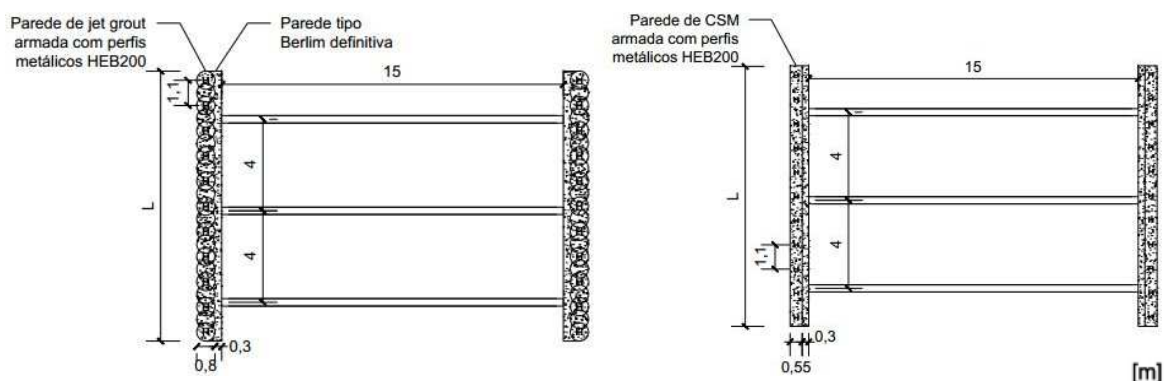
Vista em planta da escavação para as duas soluções de contenção possíveis
